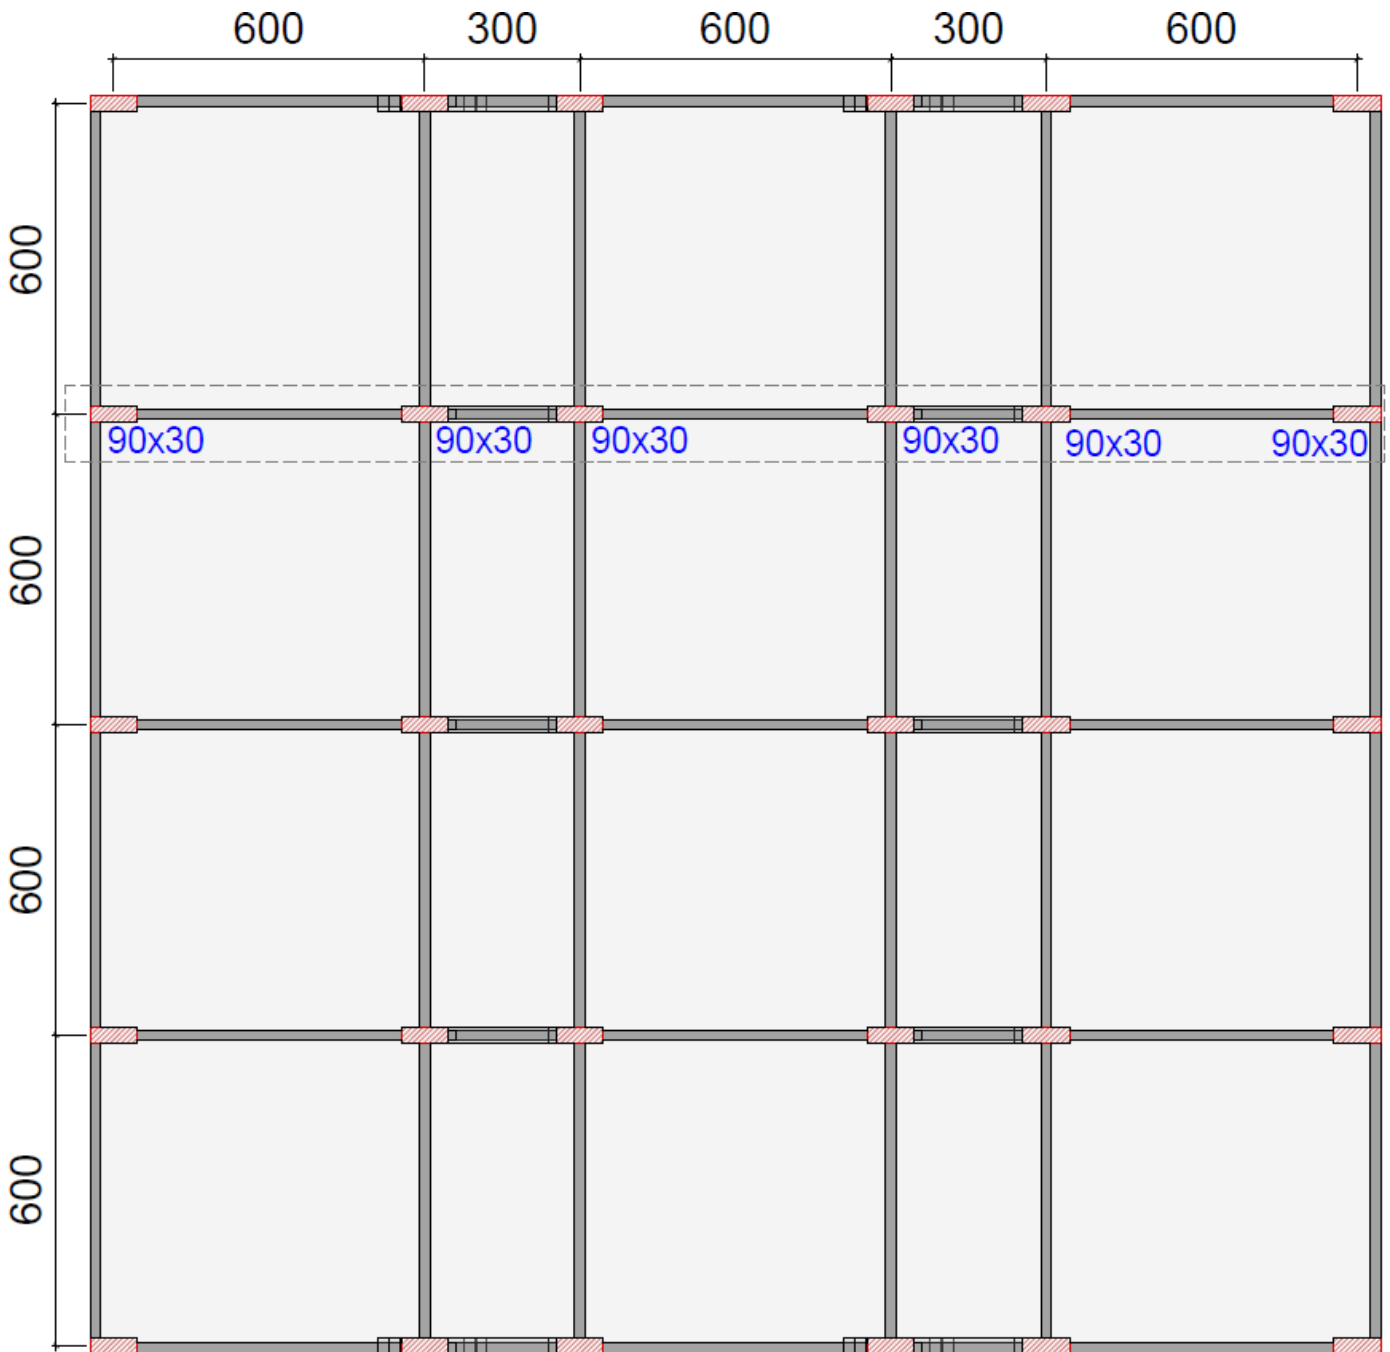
Pórtico plano de 30 pavimentos e 5 vãos: seleção na planta do pavimento tipo.
